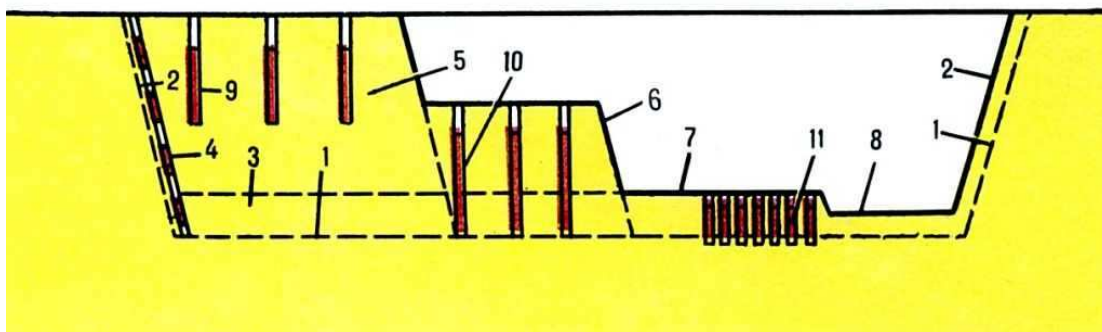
Схема розроблення котловану за допомогою вибуха: 1 – проекційний контур котловану; 2 – захисний шар у бортах; 3 – захисний шар в основі; 4 – свердловини контурного підривання; 5 – верхній робочий уступ; 6 – нижній робочий уступ; 7 – верхній ярус захисного шару; 8 – нижній ярус захисного шару; 9 – свердловинні заряди діаметром не більше ніж 200 мм; 10 – свердловинні заряди діаметром не більше ніж 110 мм; 11 – шпурові заряди
